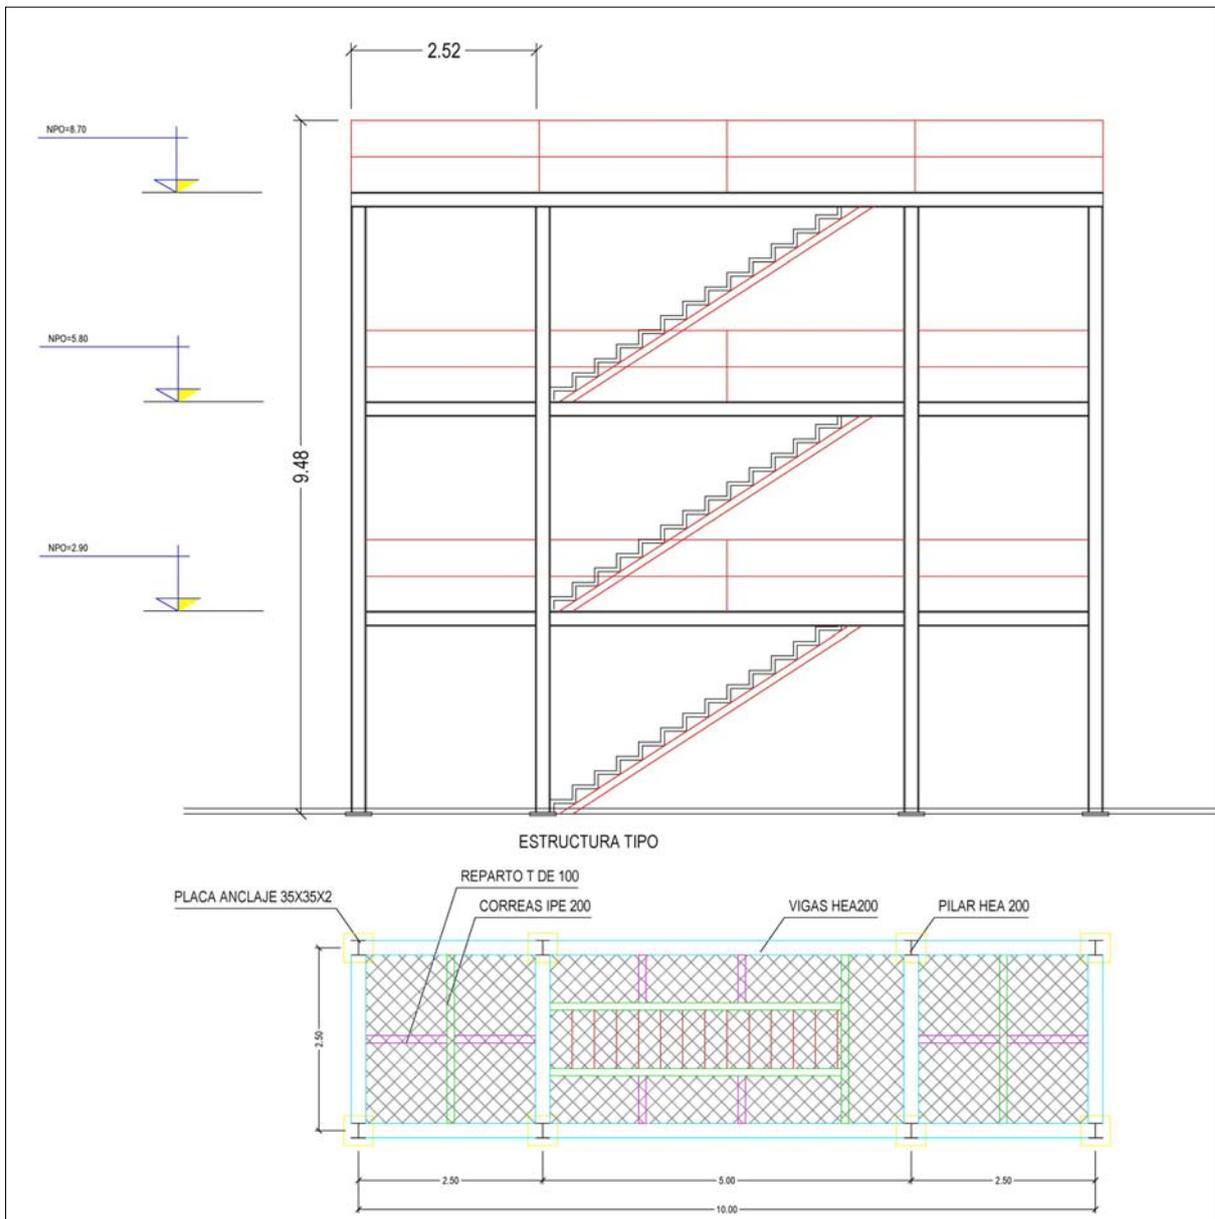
Estructura metálica para el acceso a los contenedores
